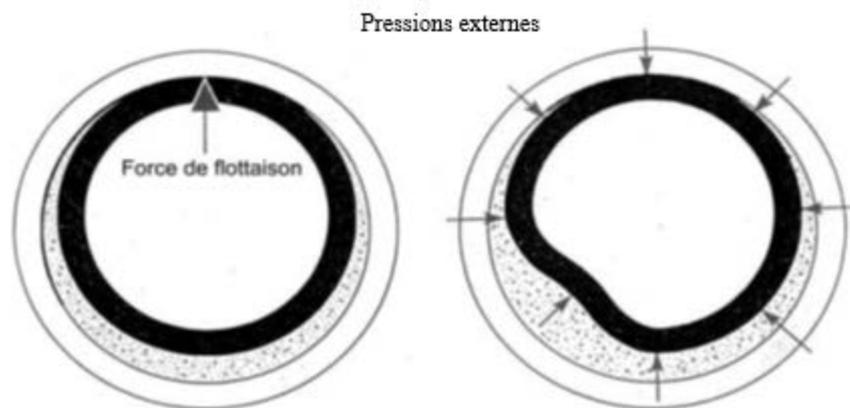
Force de flottaison et pression externe sur la conduite insérée.
